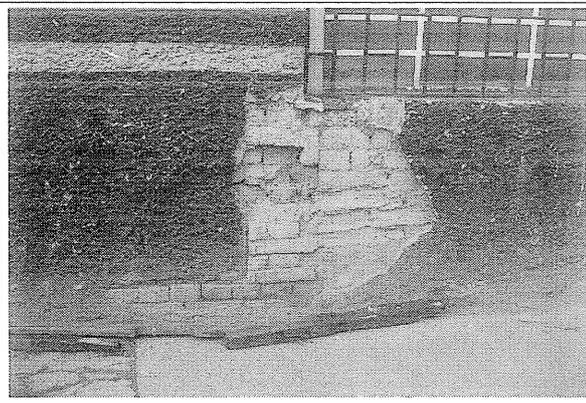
Daños en la parte inferior del muro de fachada del costado occidental.
